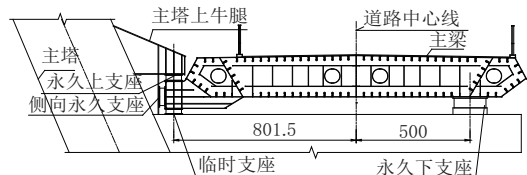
灯柱侧上牛腿及支座布置立面图(单位:cm)
